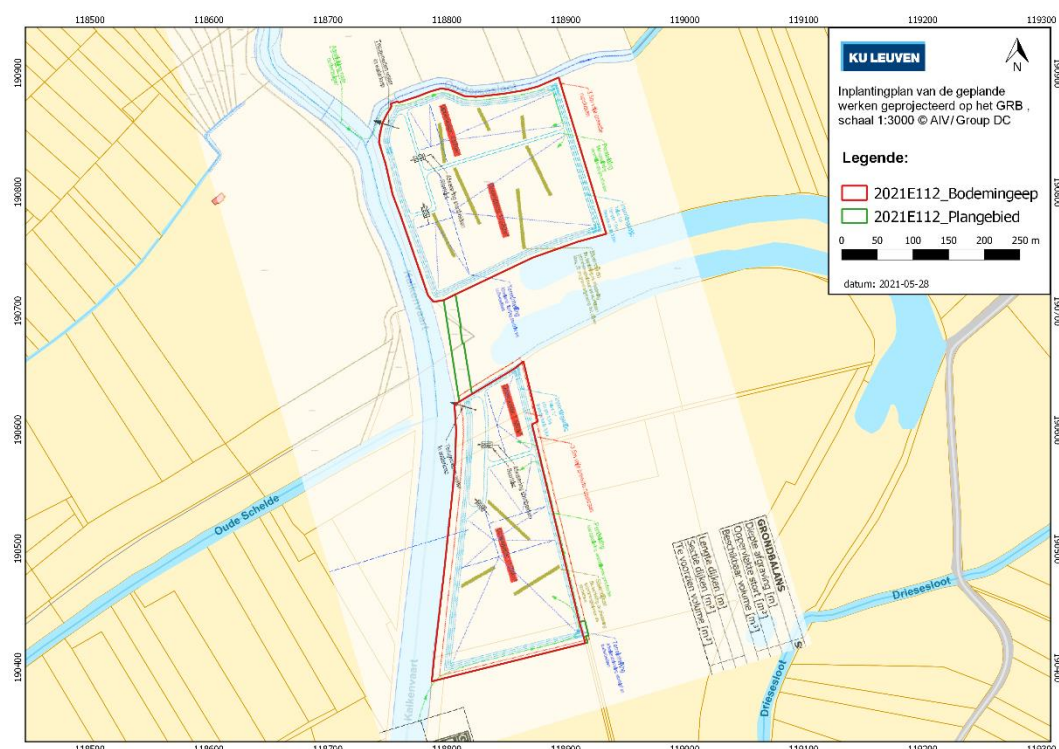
Grondplan – Stortbekkens, detail Stort Noord (© Group DC).
